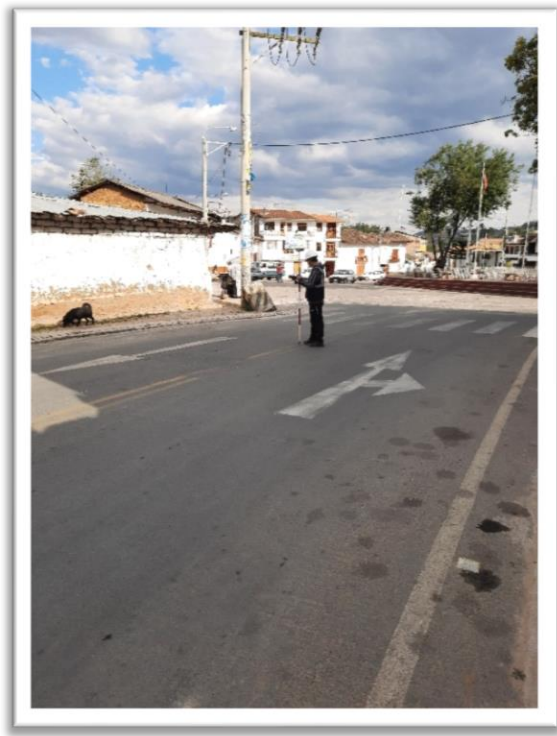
Levantamiento punto final Namora Km. 1243+000.00
